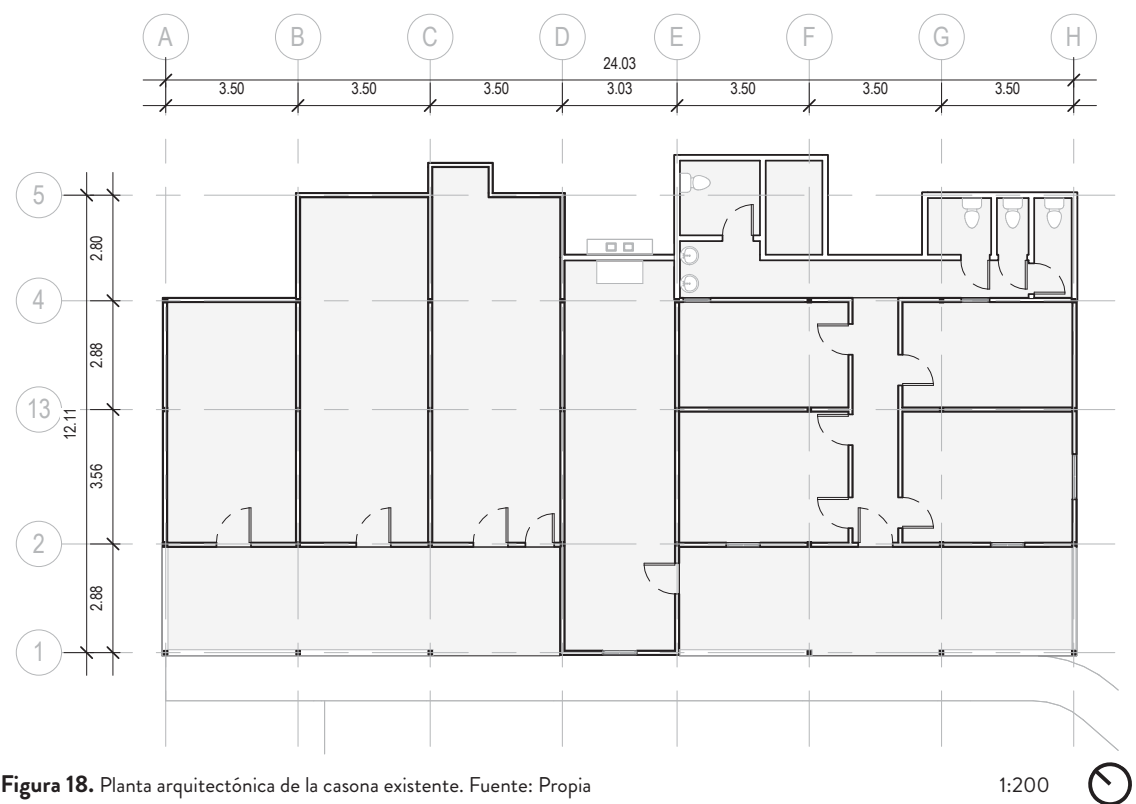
Planta arquitectónica de la casona existente. Fuente: Propia
